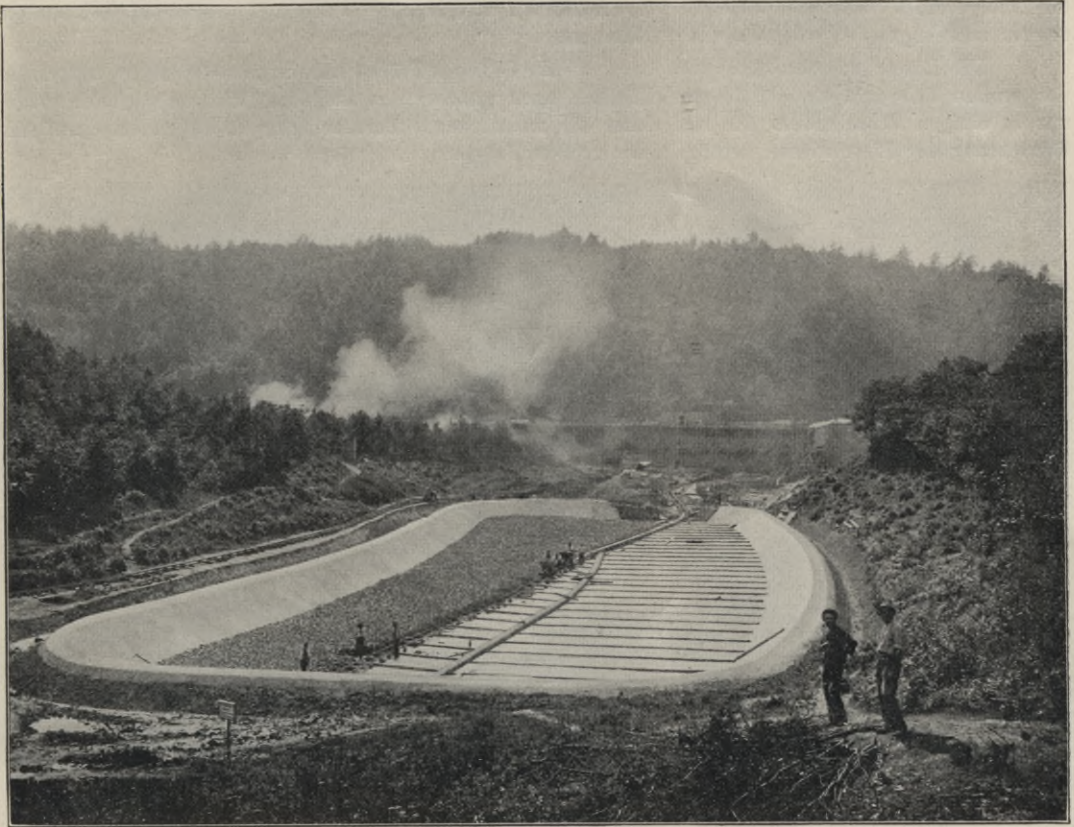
Unterwasserfilter im Vorbecken der Solinger Talsperrenanlage (im Bau). Im Hintergrunde: Verbrennen des Abraums aus dem Talbecken.
